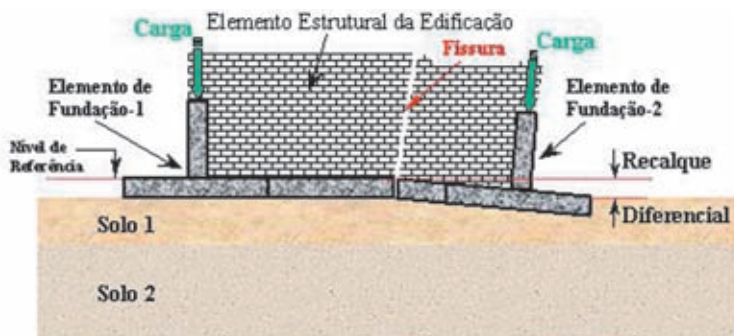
Modelo esquemático de fissura em elemento estrutural de edificação ocasionada por recalque diferencial em elemento de fundação.
